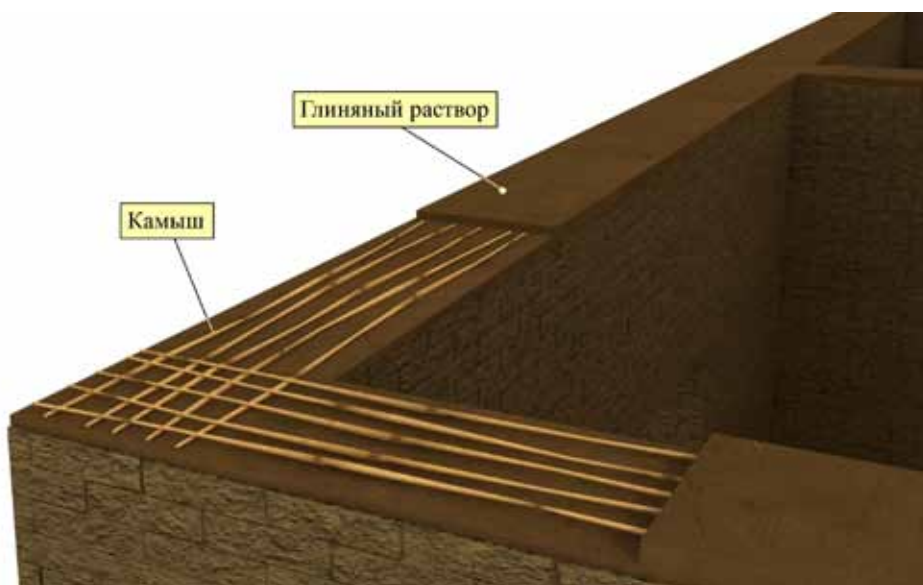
Армирование наружных стен из сырцового кирпича и глинобита камышом
